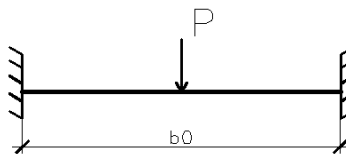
Расчетная схема для расчета на монтажную нагрузку
